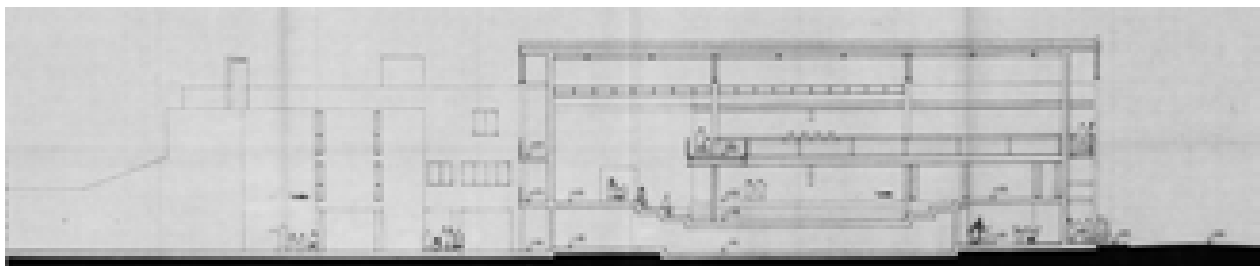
Sezione BB, stato attuale –09/12/1997 (AABS-1996.508)
